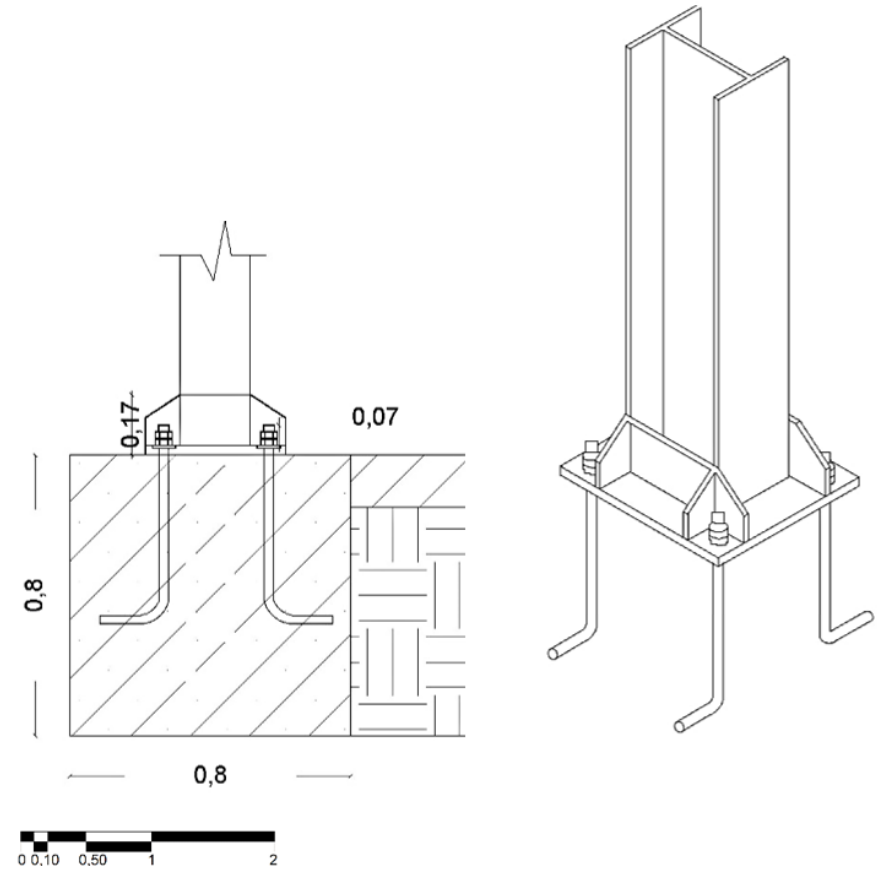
Detalle constructivo b-b del mobiliario de las paradas más utilizadas, escala 1:25. Elaboración propia.
